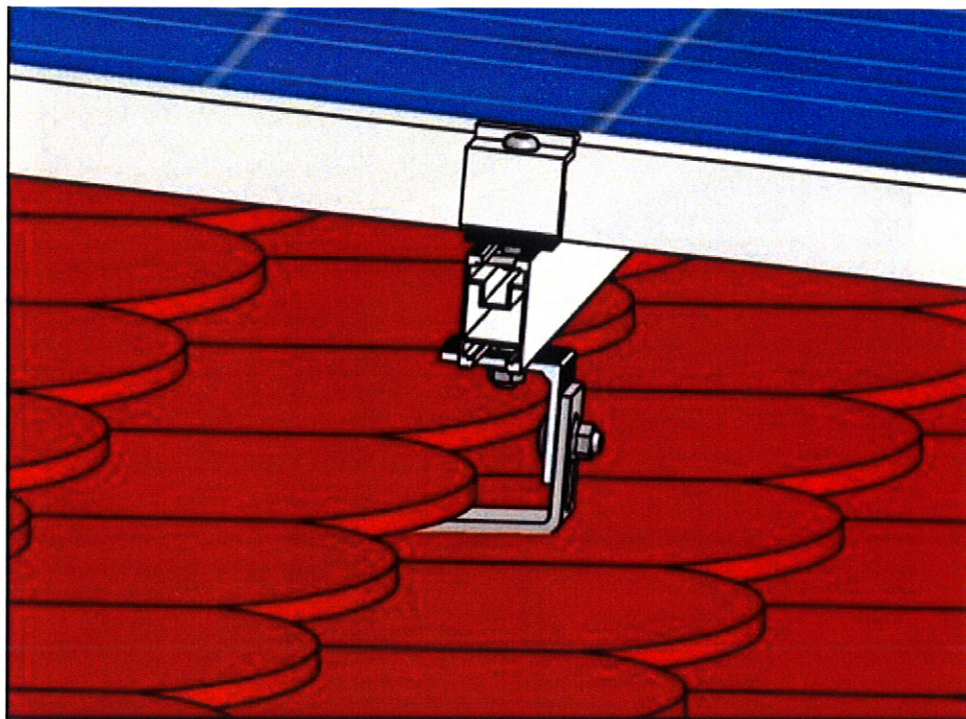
Rysunek przykładowej konstrukcji dachówka ceramiczna
